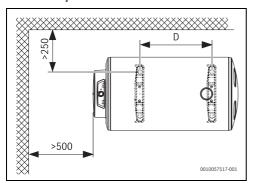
Dimensões em mm (montagem mural, instalação horizontal)
